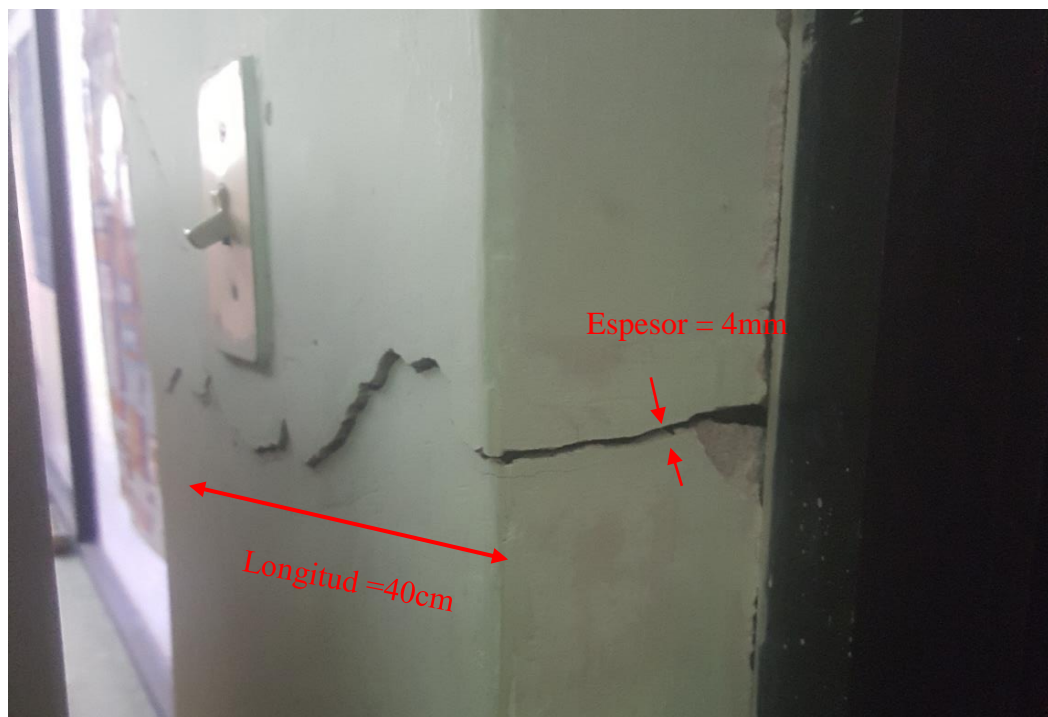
Grieta en mampostería (No existe columna en la zona), Planta baja eje D entre 1 y 2
